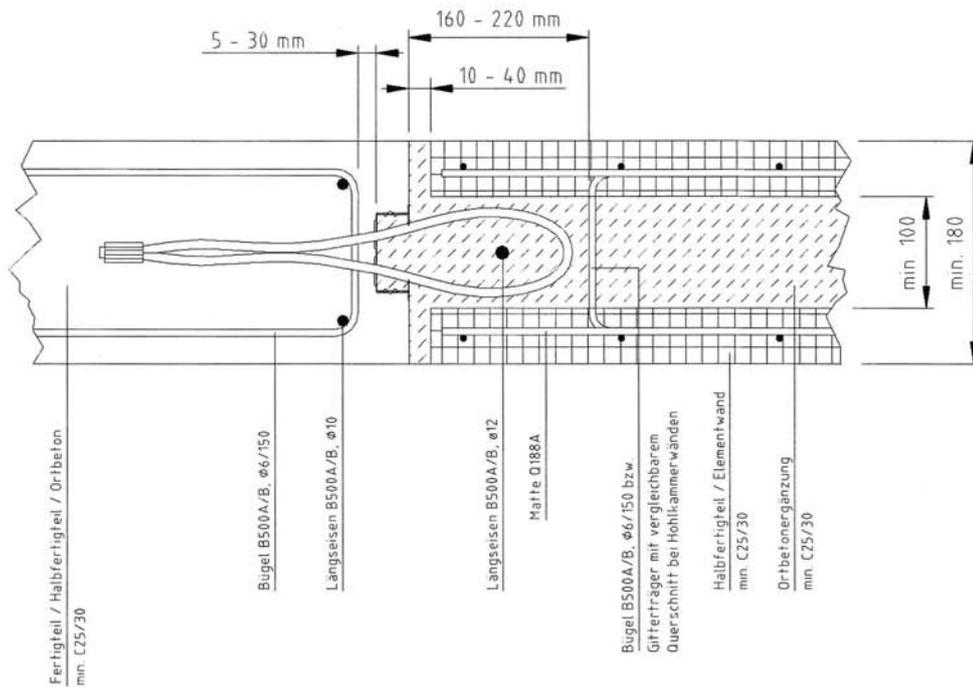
Querschnitt Halbfertigteile / Elementwand, Bewehrung
